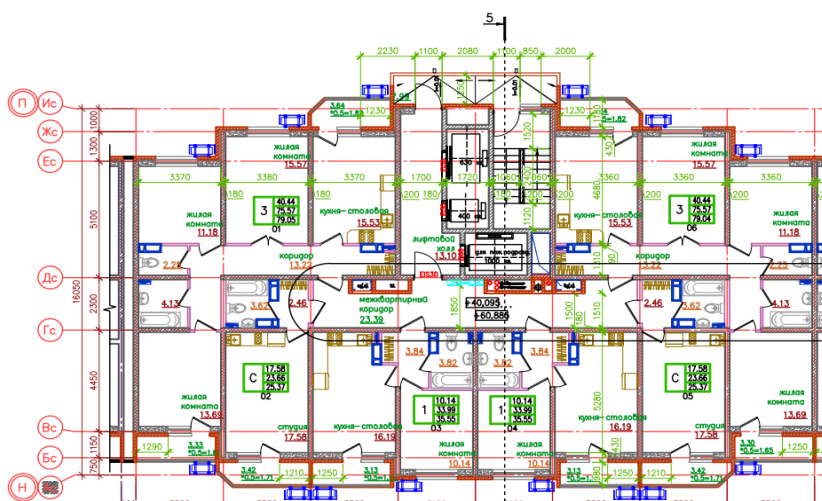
Типовой план 14-21 этажа БС-6 ЖК URAL
